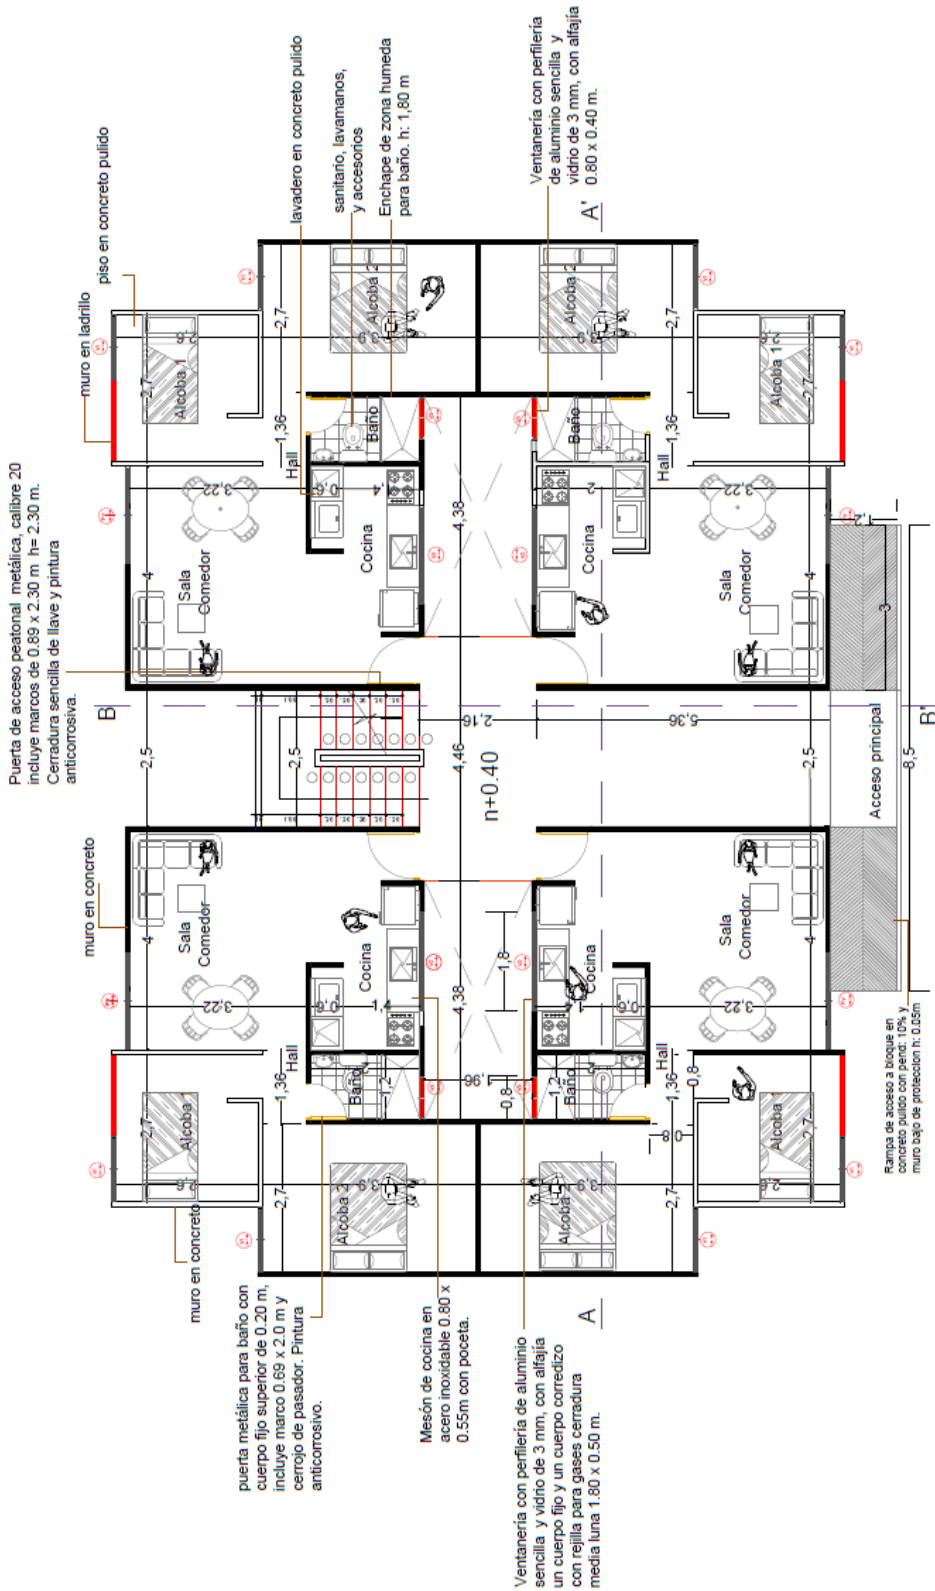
Plano Constructivo- Detalles Estructurales piso tipo- Fuente: Autor
